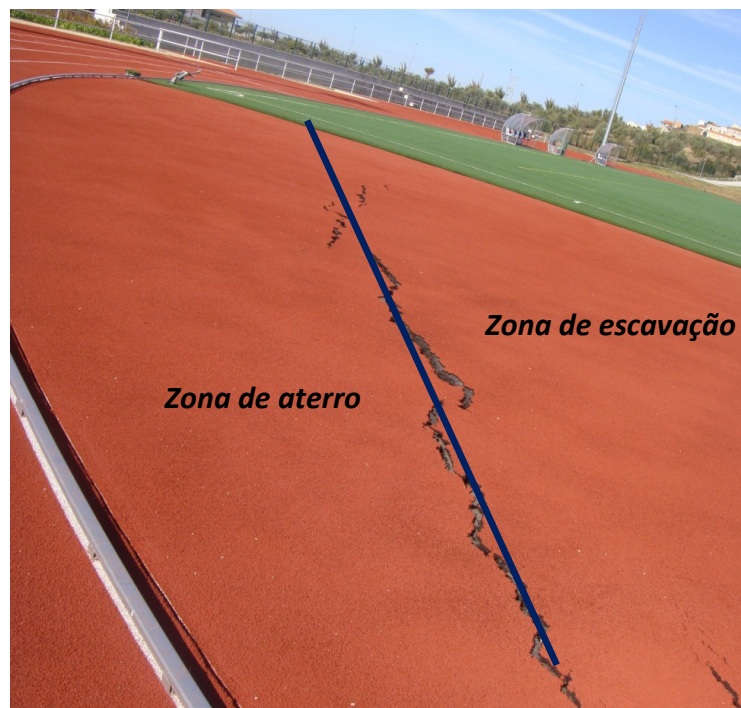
Possível linha de separação da zona de aterro e de escavação
